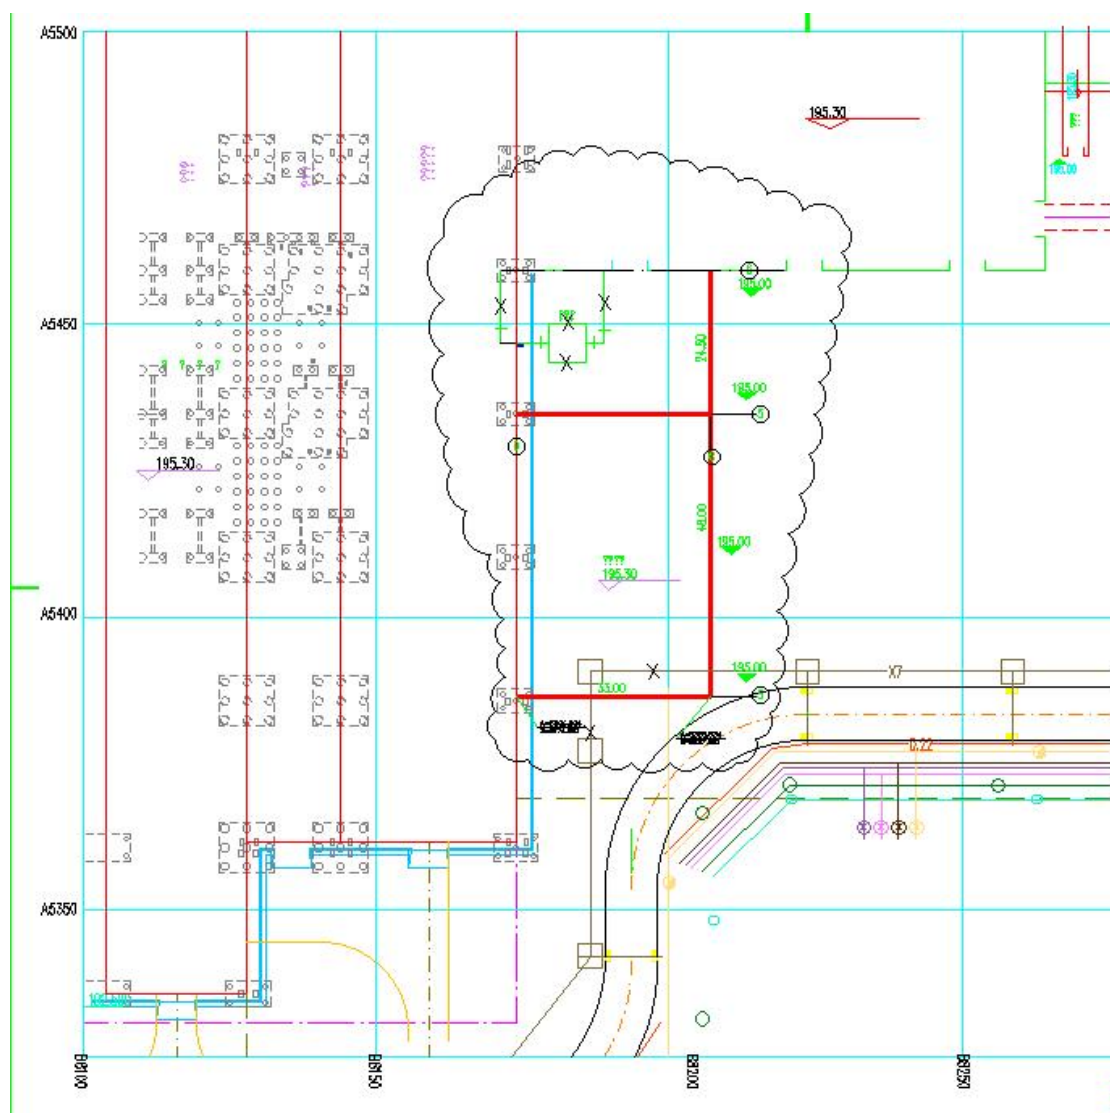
炼钢主厂房总平面布置 (图中云线部分)
